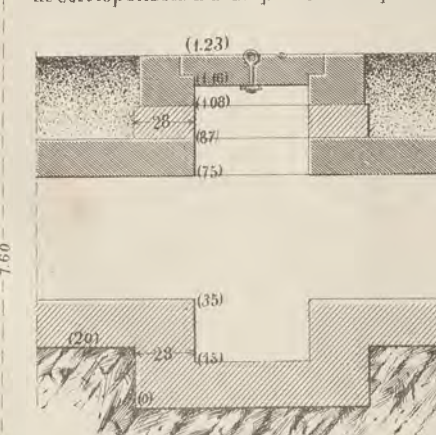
<sup>a</sup> Proiezione orizzontale della bocca di un pozzetto d'esplorazione.
